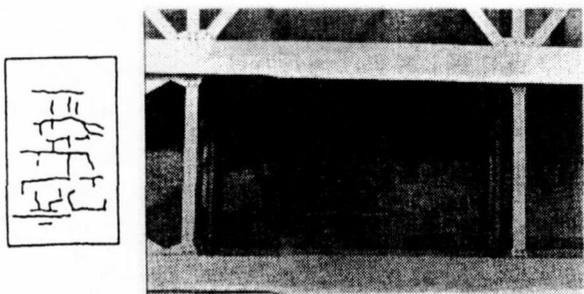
直交2方向のひび割れ<sup>31)</sup>
